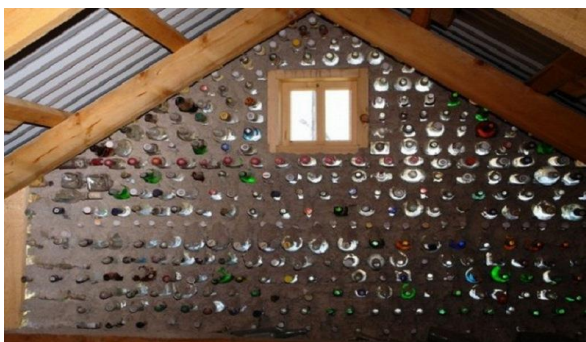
Фасад жилого дома, выполненный из бутылок
